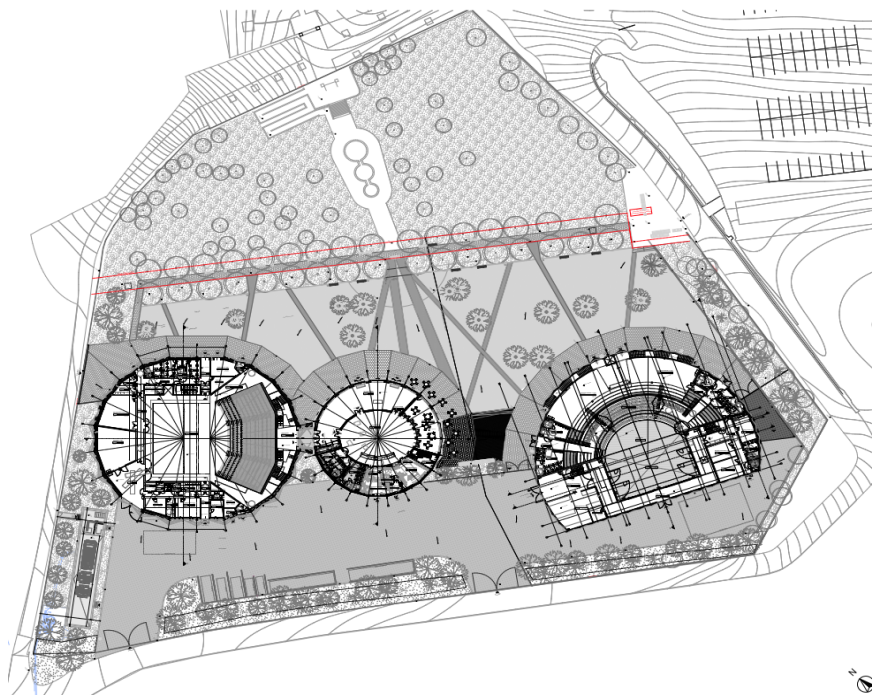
Plan masse du projet RDC (Bâtiments A, B, C)
